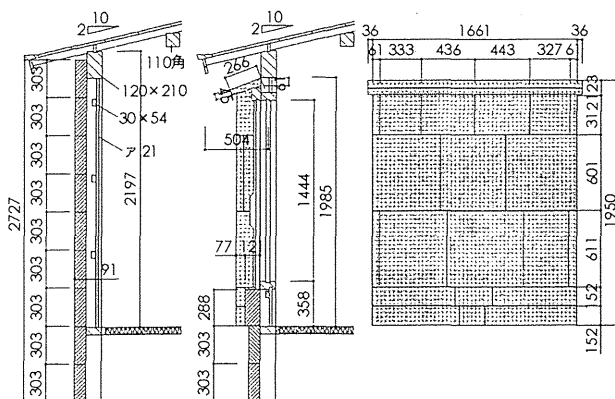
積み石のオーヤ断面図 (S=1:60) (通し番号 2)
